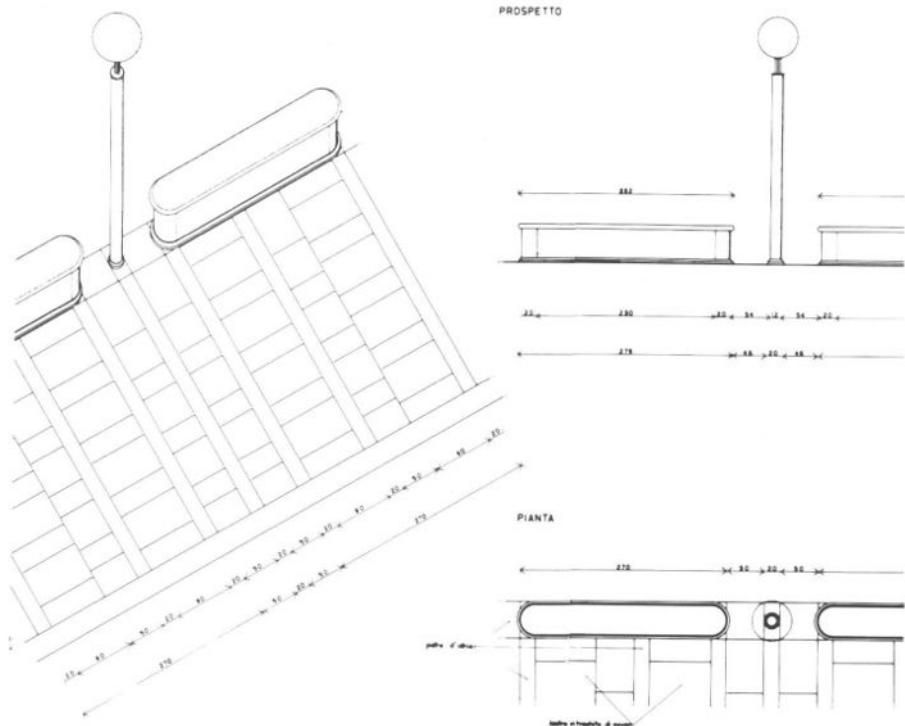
Padova: progetto di pavimentazione, panchine e lampione a stelo.
